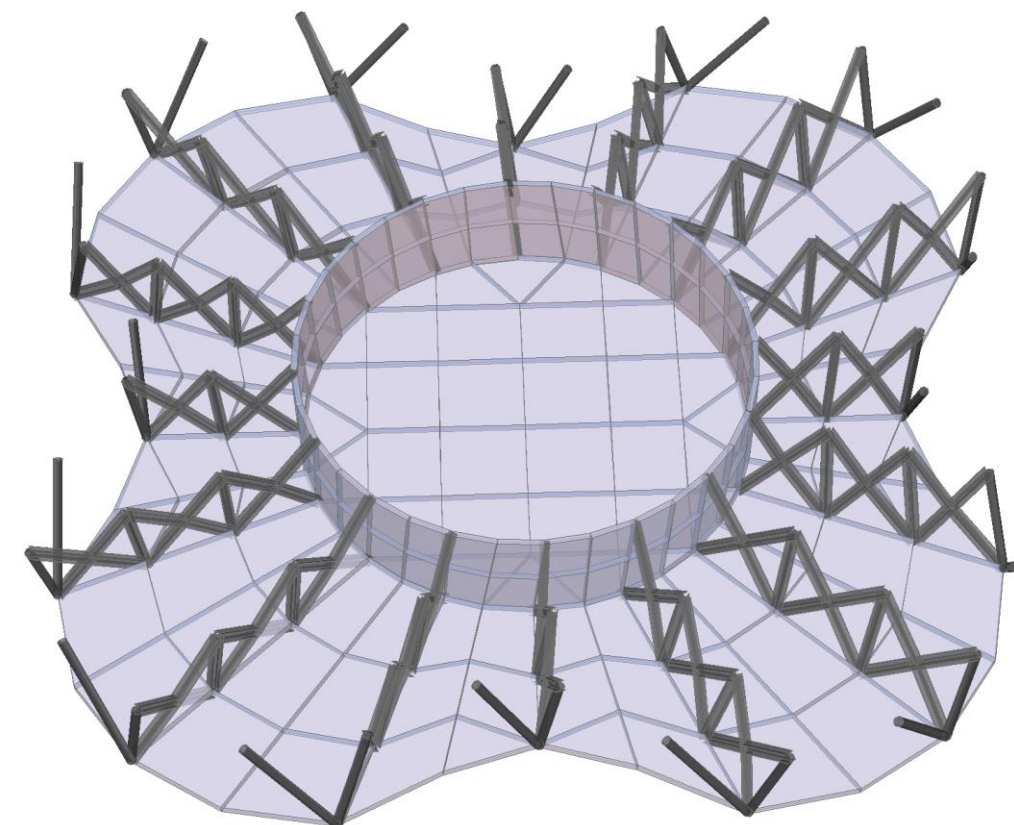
Detalle de la planta técnica (+29) con las rigidizaciones en cruces de san Andrés.
